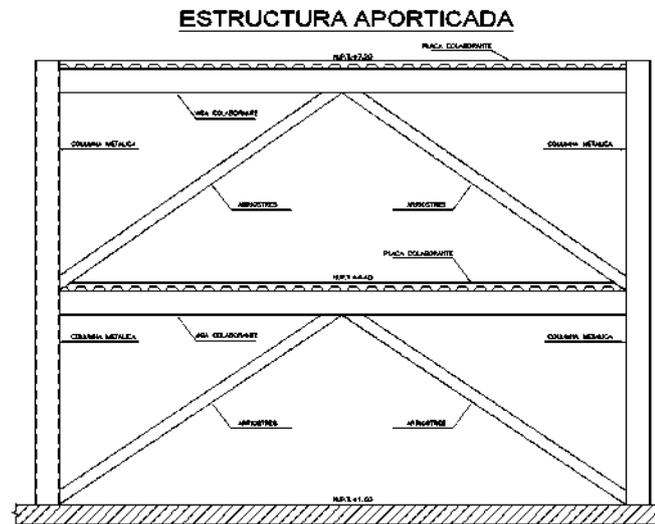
Sistema Aporticado. FUENTE: Elaboración Propia
